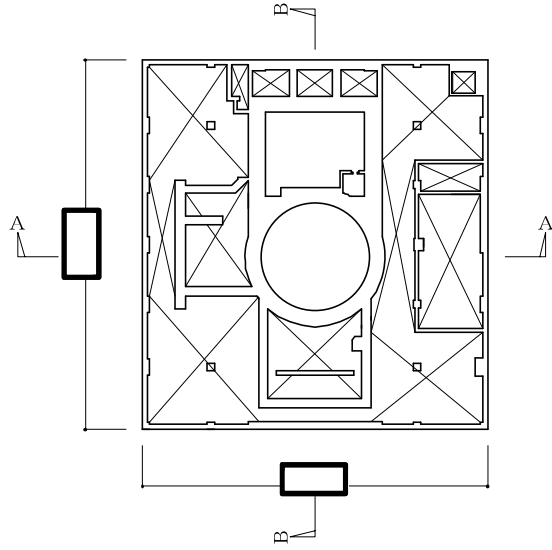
(7/9)  の概略平面図 (EL. 34.7 m)
